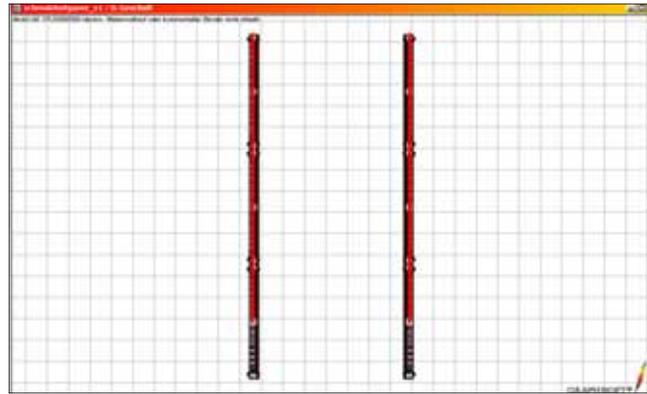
Grundriß der Ebene: "Objekt14_lampers"
